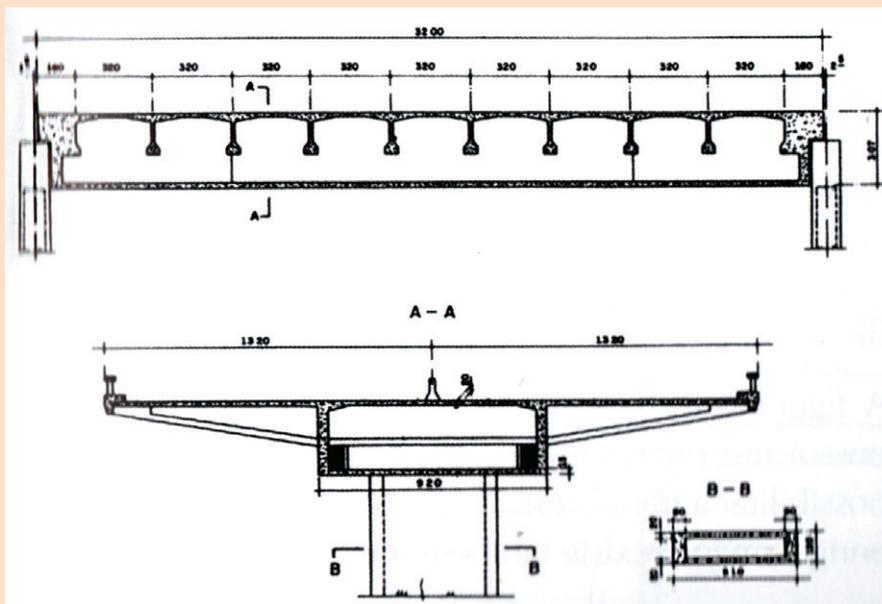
VIADUTO DA AV. RIO DE JANEIRO: TRECHO EM CAIXÃO COM VÃO DE 32 M MOLDADO NO LOCAL, PORÉM COM TRANSVERSINAS PRÉ-MOLDADAS (REPRODUZIDA DE [6])
